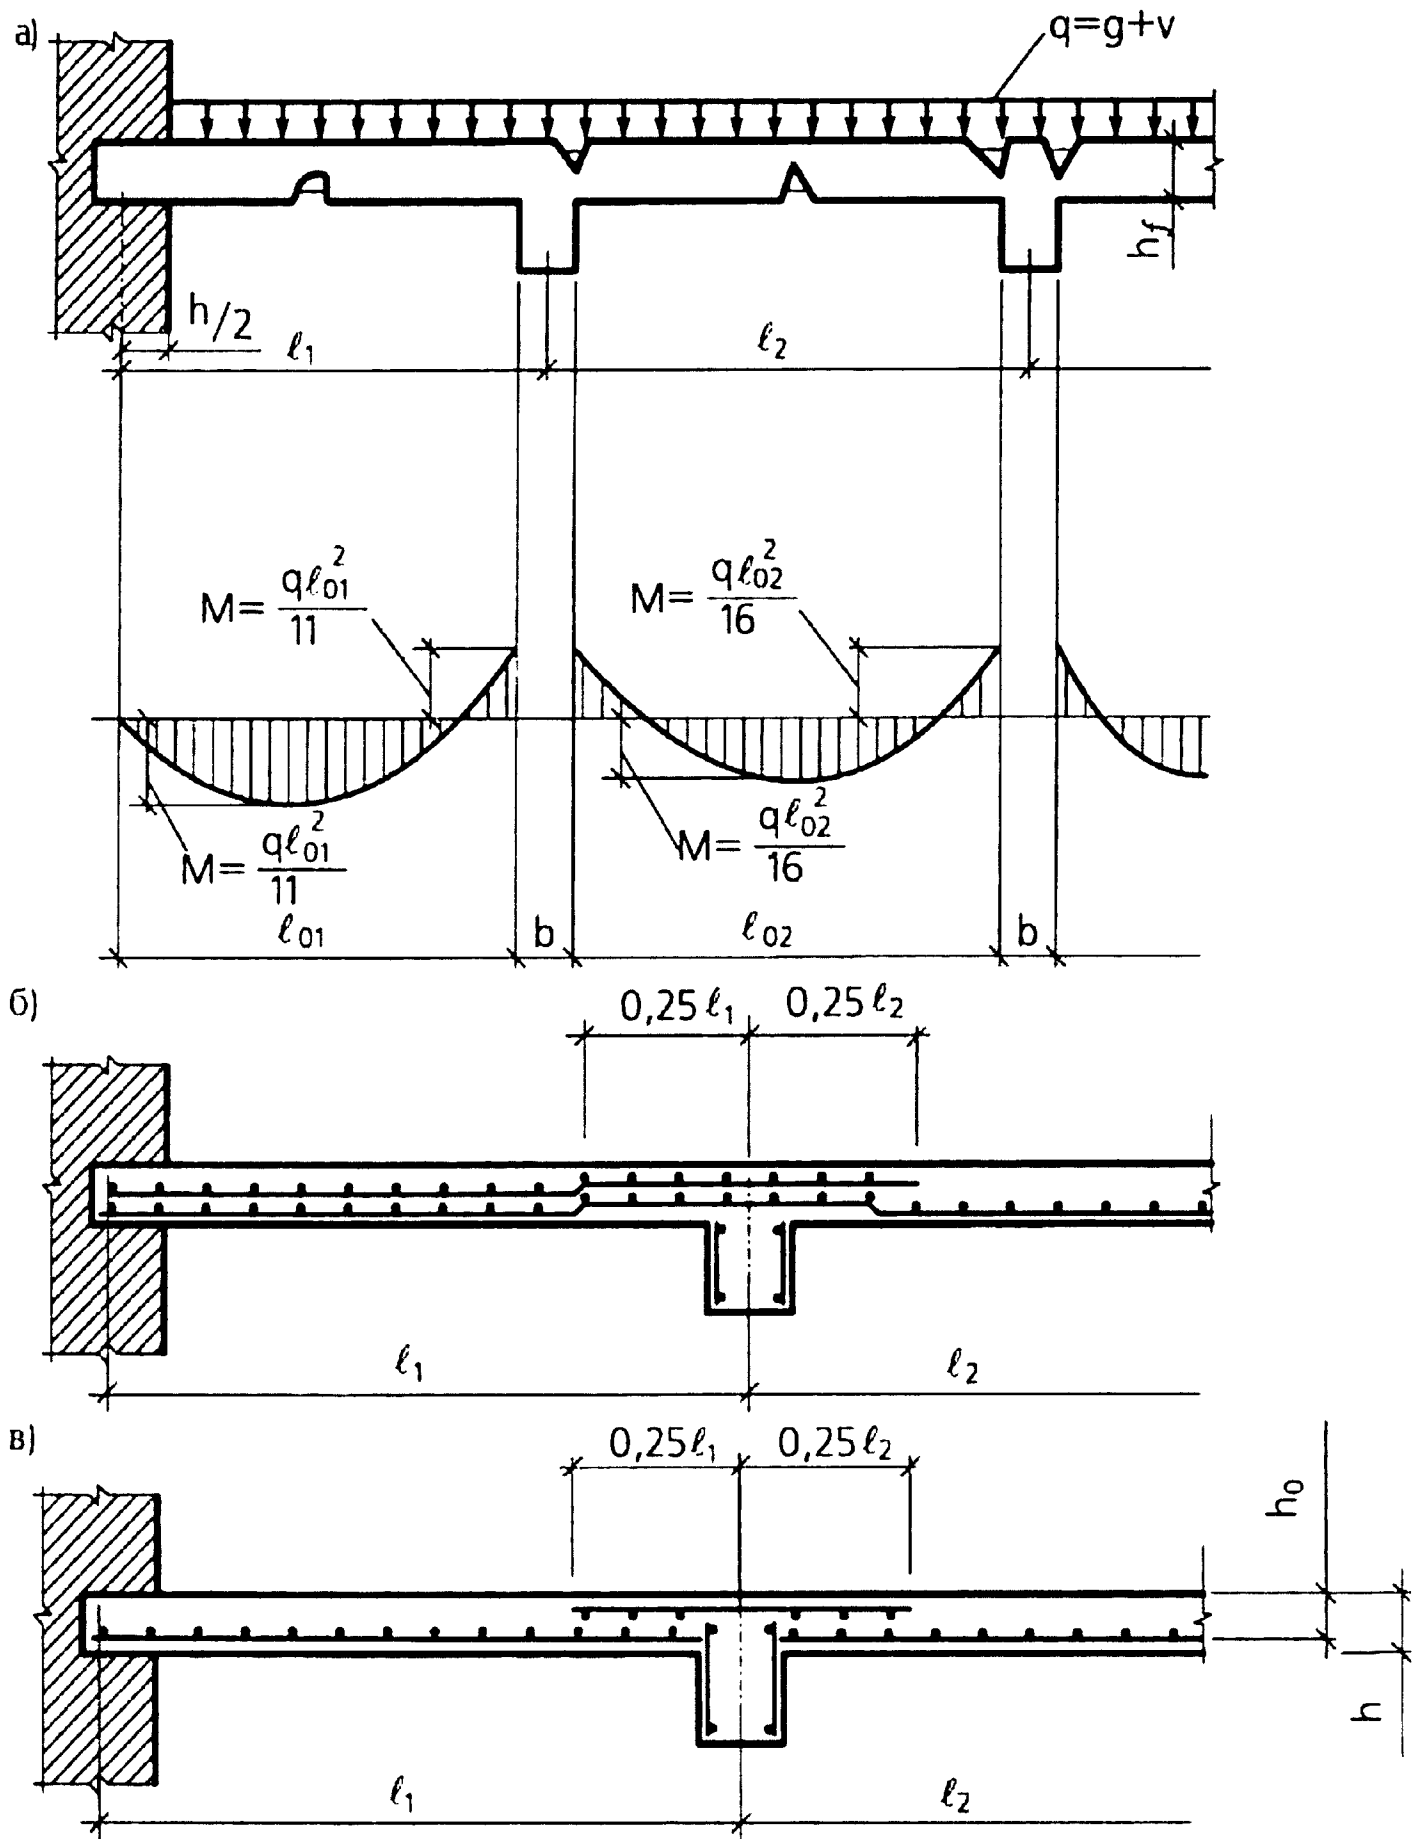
Армирование монолитных балочных плит: а - эпюра моментов с учетом перераспределения усилий; б - непрерывное армирование; в - раздельное армирование
